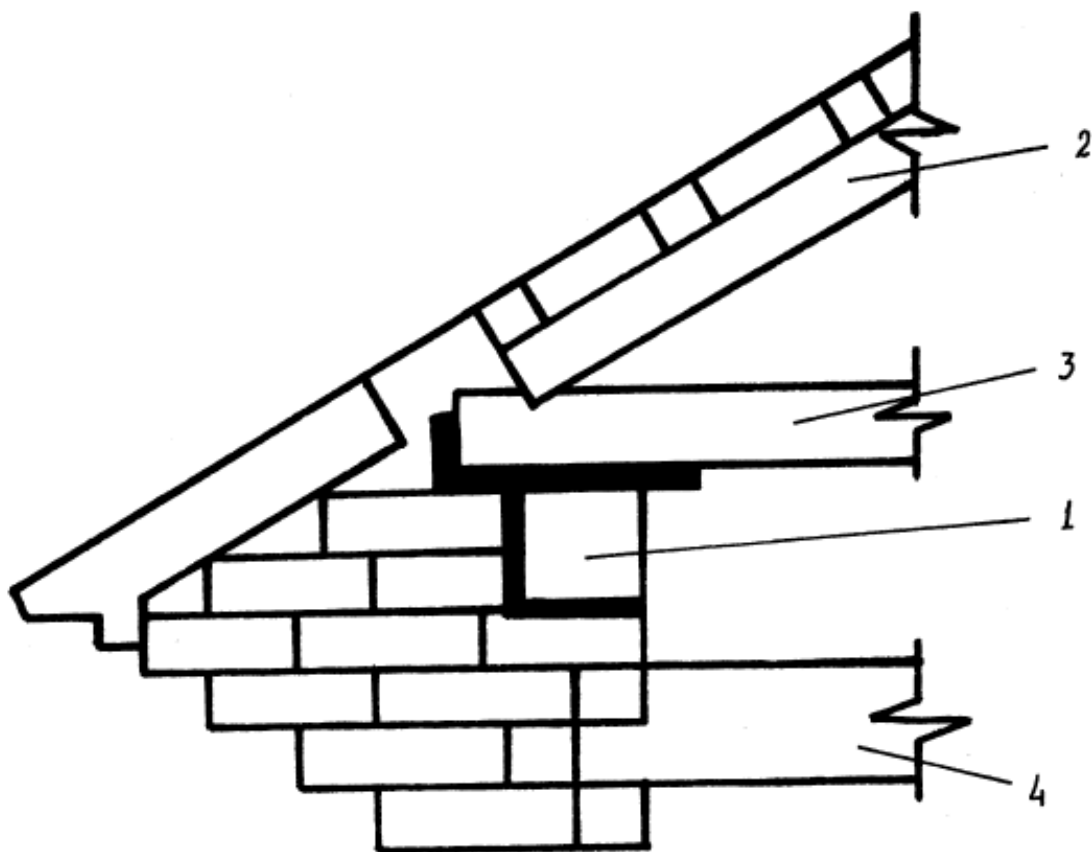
Крепление стропильных ног на верхние венцы. 1 – шип, 2 – стропильная нога.
